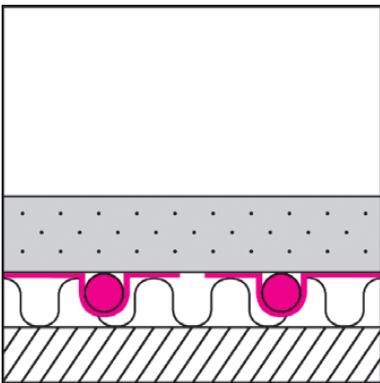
NB3 – Verbundkonstruktion: Rohrsystem auf Altuntergrund in Ausgleichsmasse/-estrich
